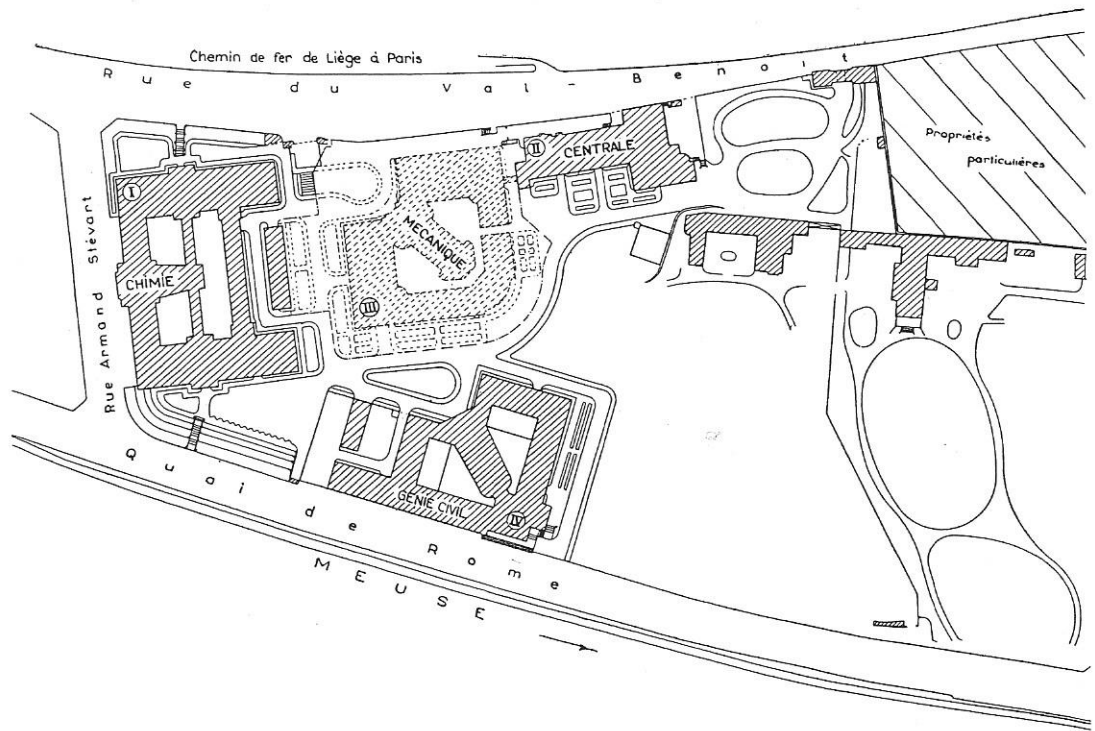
Plan général de situation des nouveaux bâtiments universitaires du Val-Benoît à Liège
